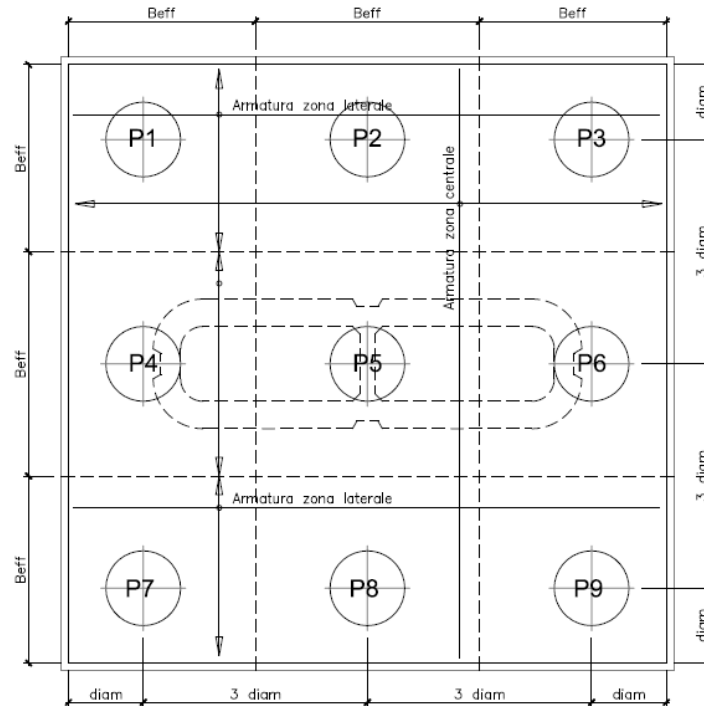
Plinto di fondazione – Armatura longitudinale inferiore e superiore
